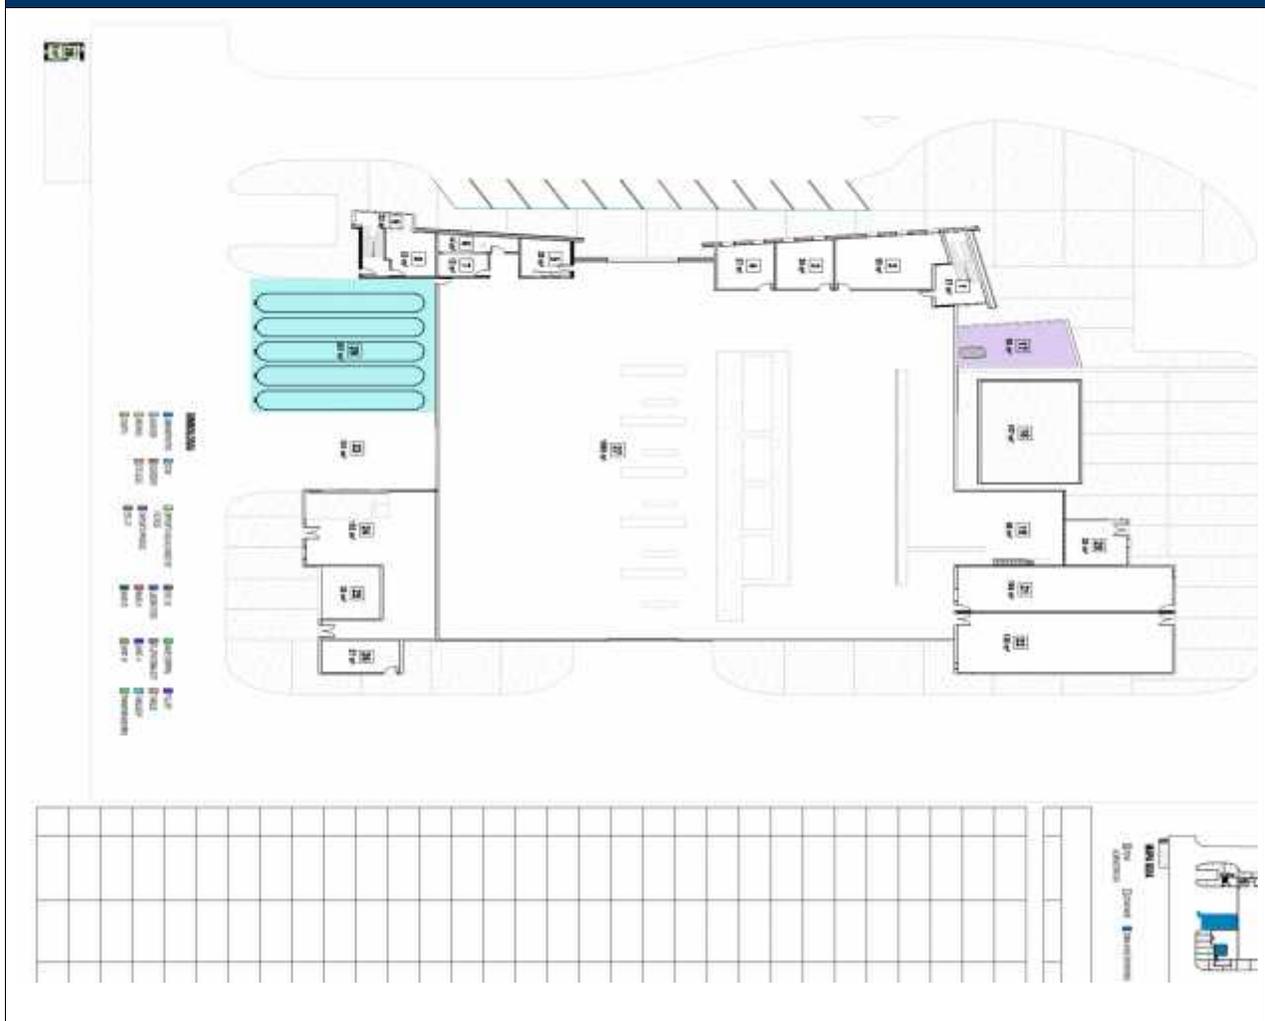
Arreglo general de la Planta Desalinizadora
